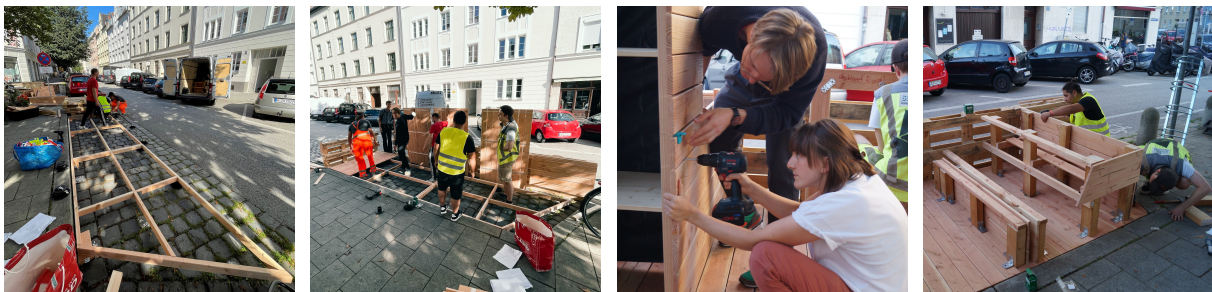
Vorbau der einzelnen Elemente (oben), Installation vor Ort (unten)
